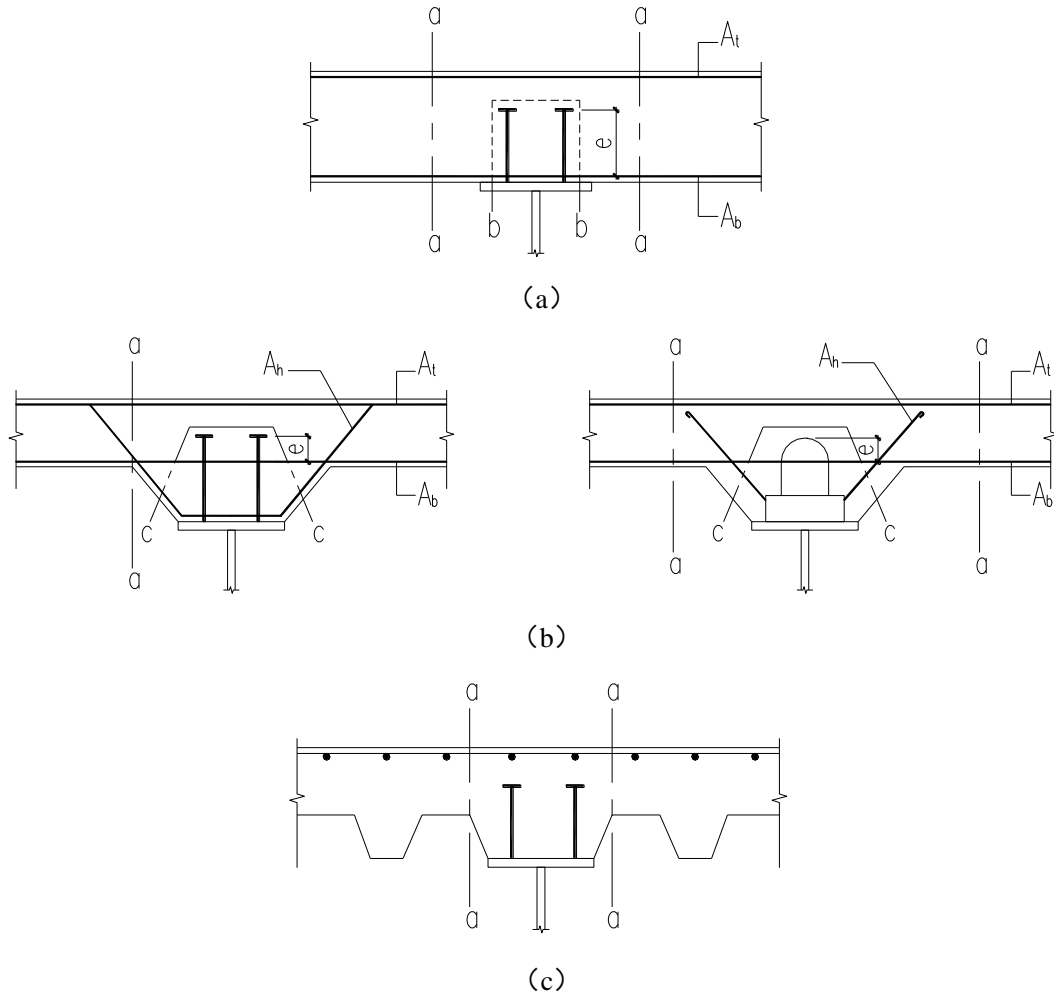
组合梁混凝土翼板与板托纵向受剪面及横向钢筋
